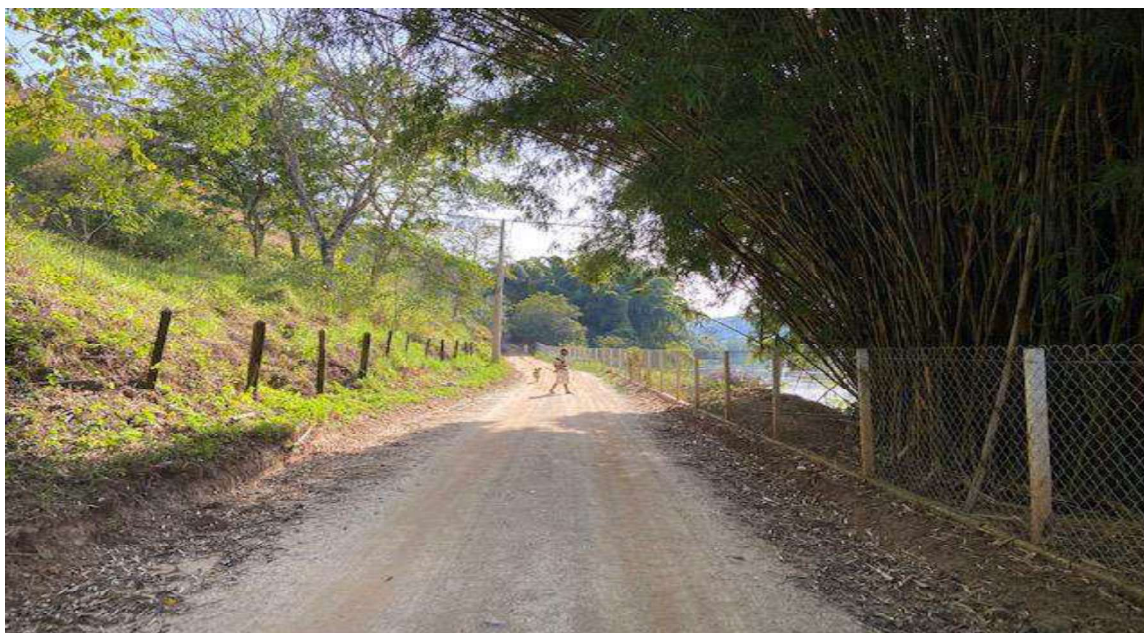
Vista do logradouro (Avenida Joaquim Vieira da Silva)
